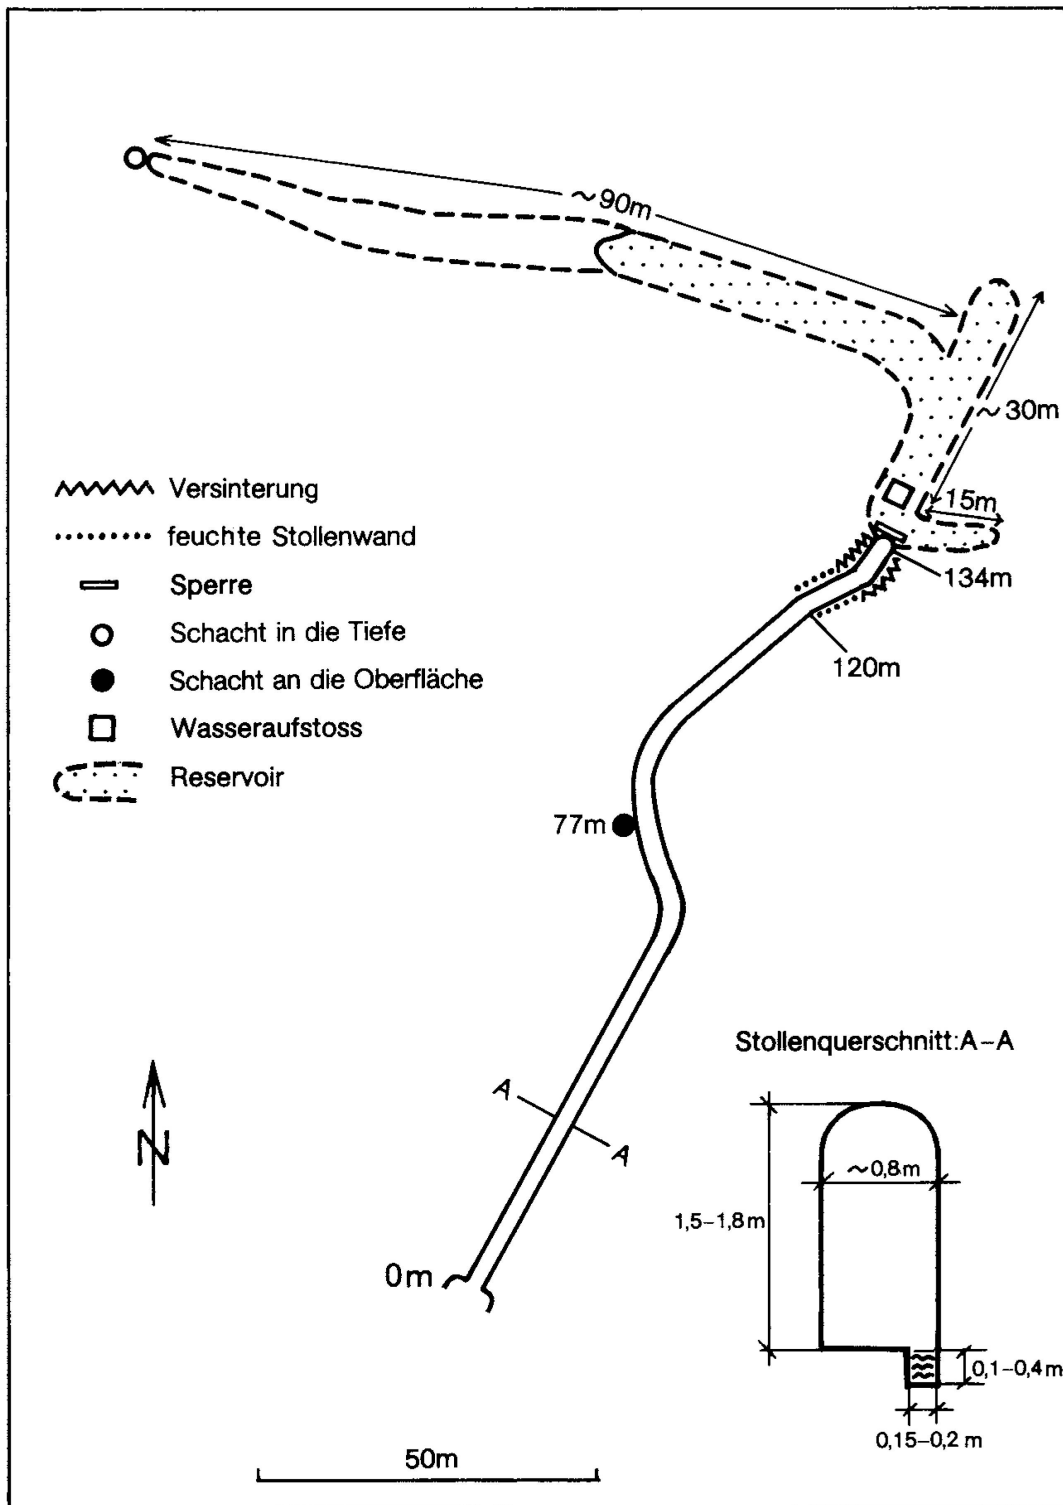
Plan zum Brunnenstollen Willershüseren. Die Gesamtlänge beträgt rund 250 m.
